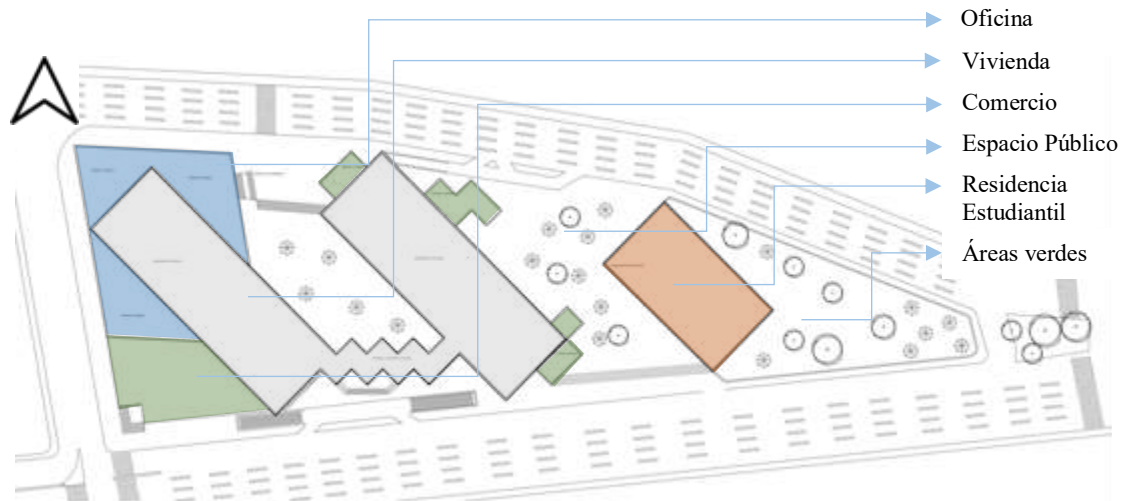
Propuesta de zonificación de conjunto en planta, etapa b.
